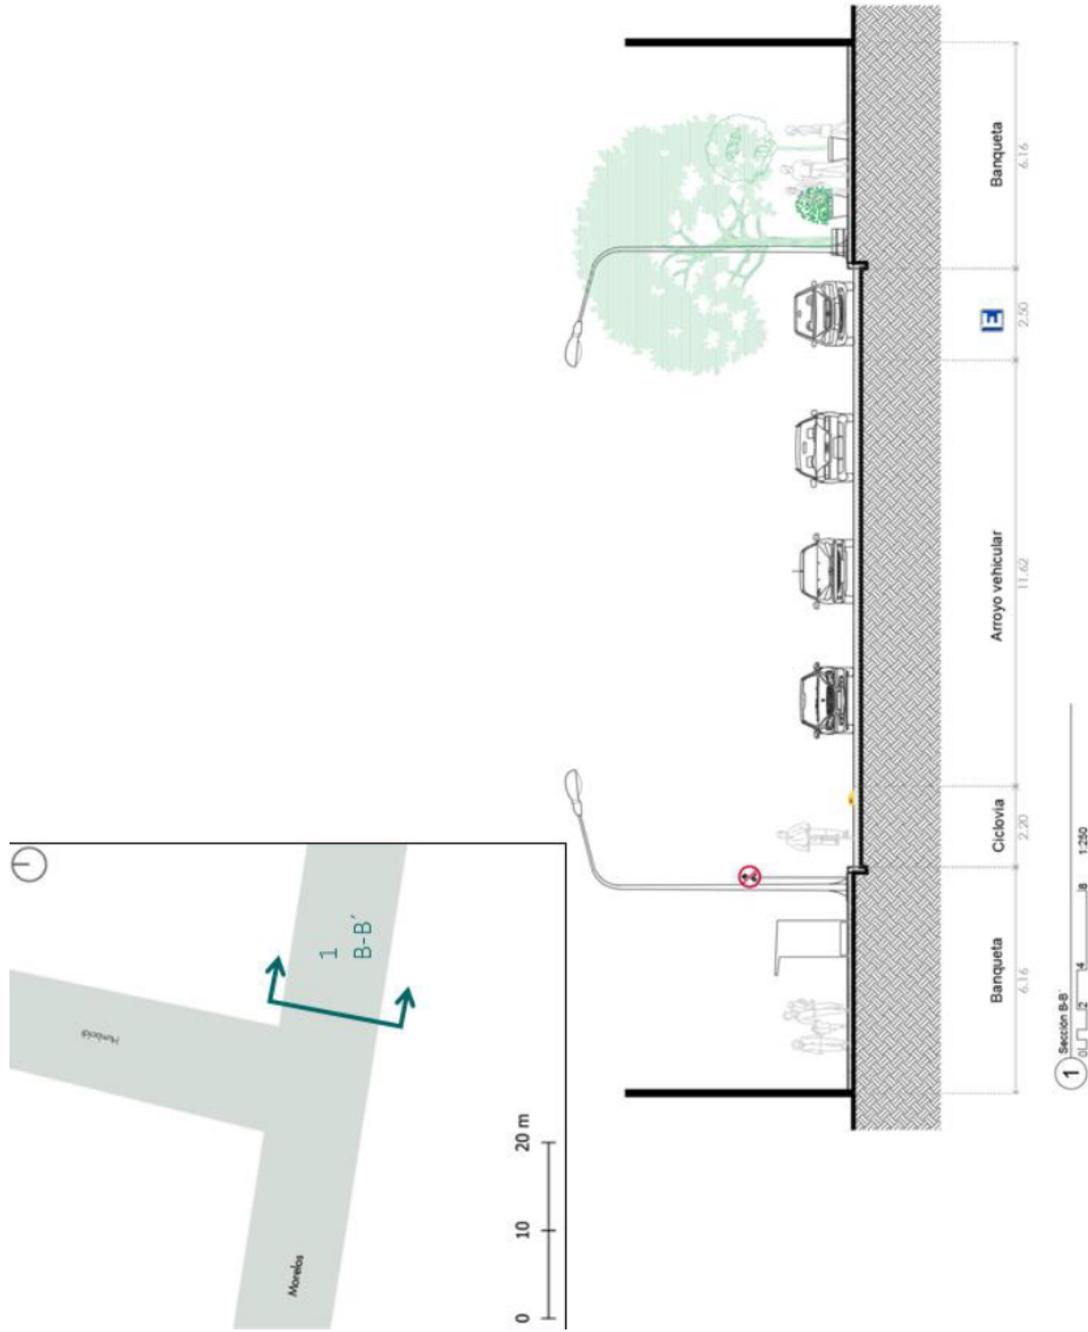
Sección transversal B-B'. Fuente TEUP
